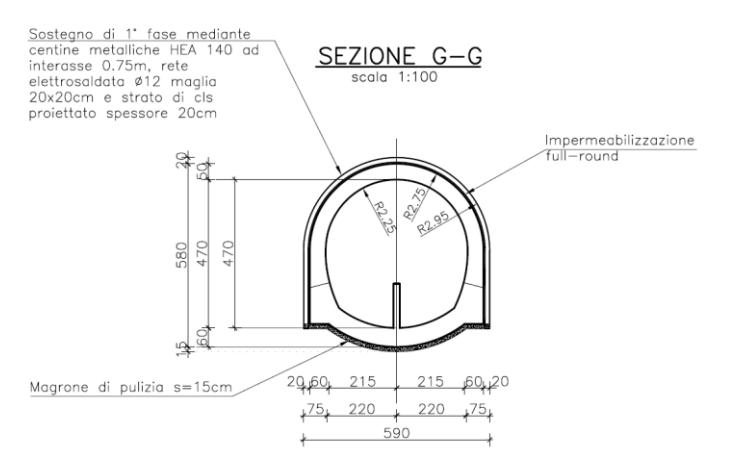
Esempio di opere di contenimento degli scavi per cabina tecnica e pozzo verticale – Sezione trasversale.
